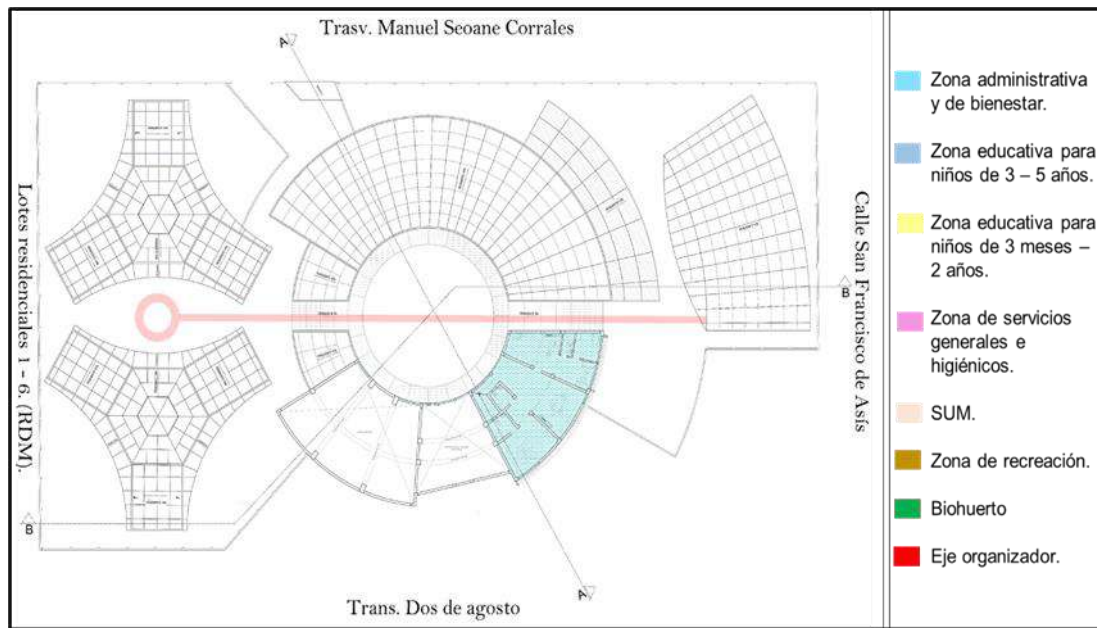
Planta arquitectónica segundo nivel de la Cuna Jardín.
